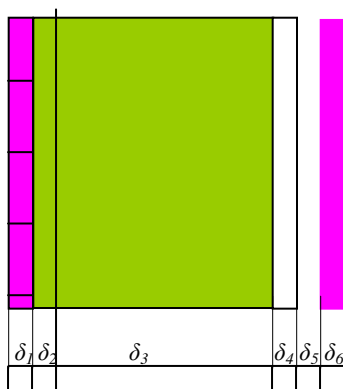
Схема поперечного перерізу зовнішньої стіни:
